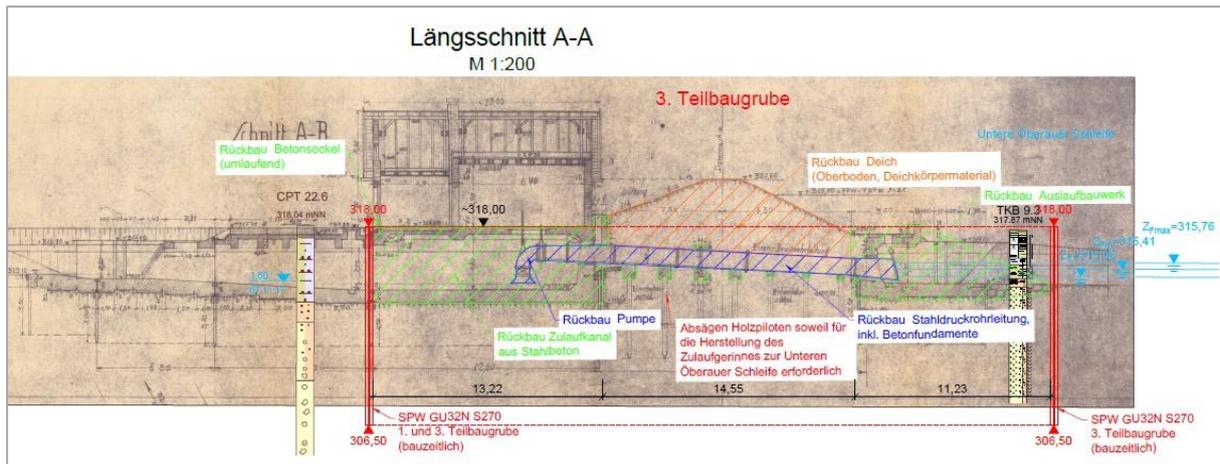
Ausschnitt aus Detaillageplan und Bauwerksschnitte Abbruch Schöpfwerk Öberau, Plan-Nr. 04-11-05, Blatt 7/7
